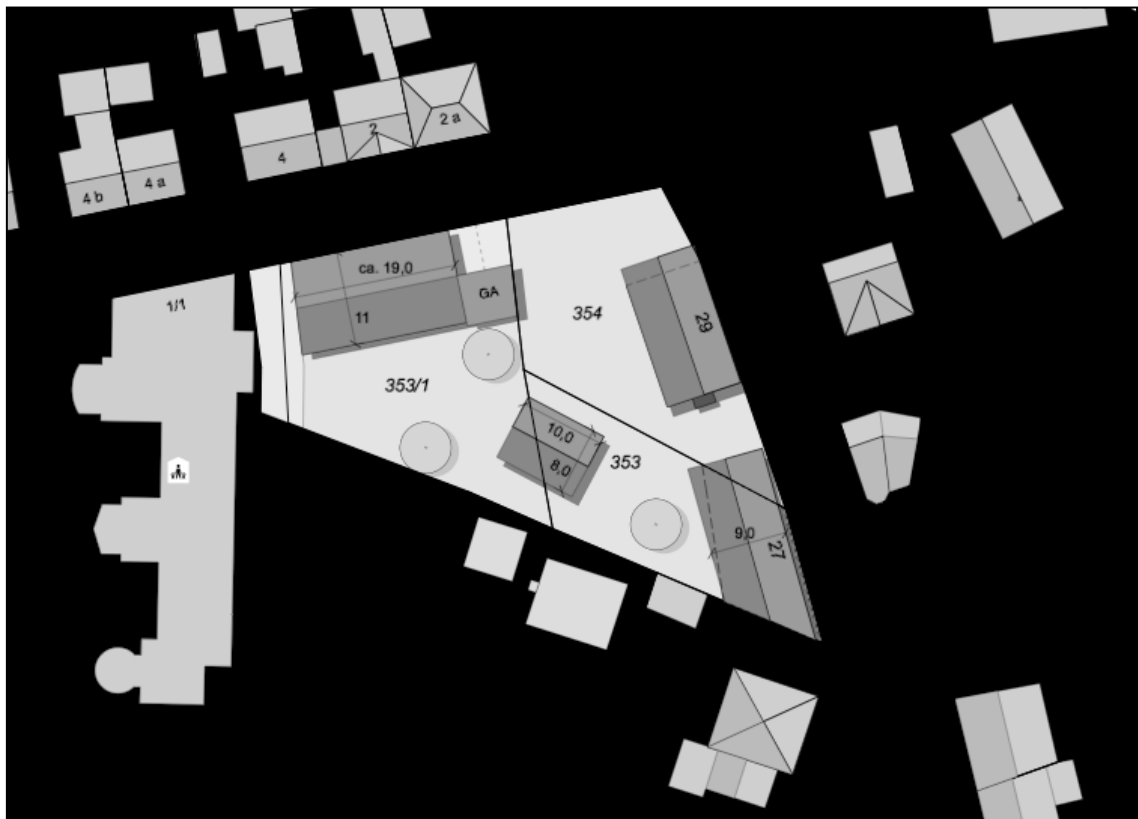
Städtebaulicher Entwurf Bebauungsplan Nr. 71 "Gartenstraße - B 3", (ohne Maßstab), Stand 15.11.2021, Eichler + Schauss, Darmstadt
